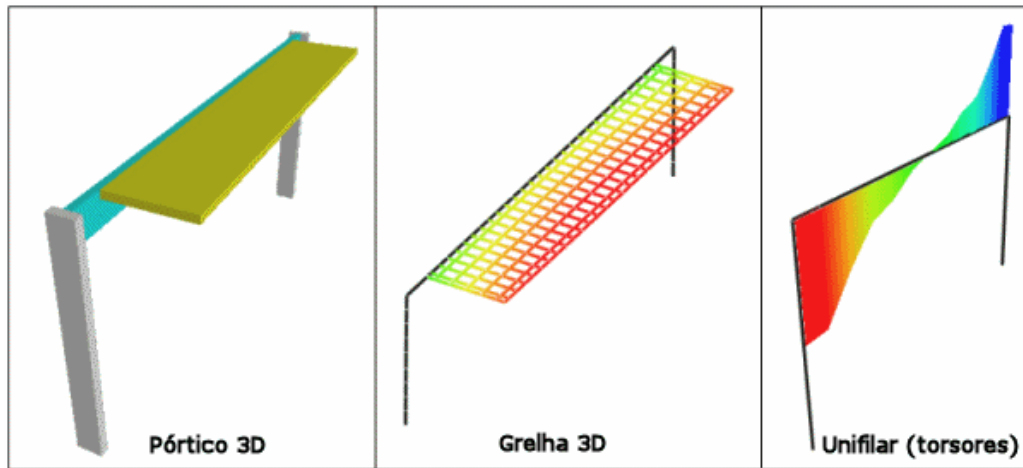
Modelo de pórtico com viga sujeita à torção devido à laje em consola, *Eberick Next* [131]
